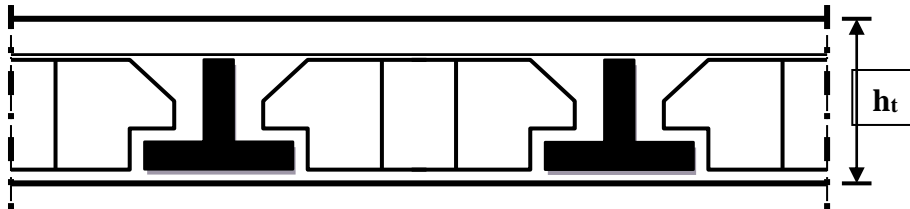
Coupe transversale d'un plancher à corps creux.
